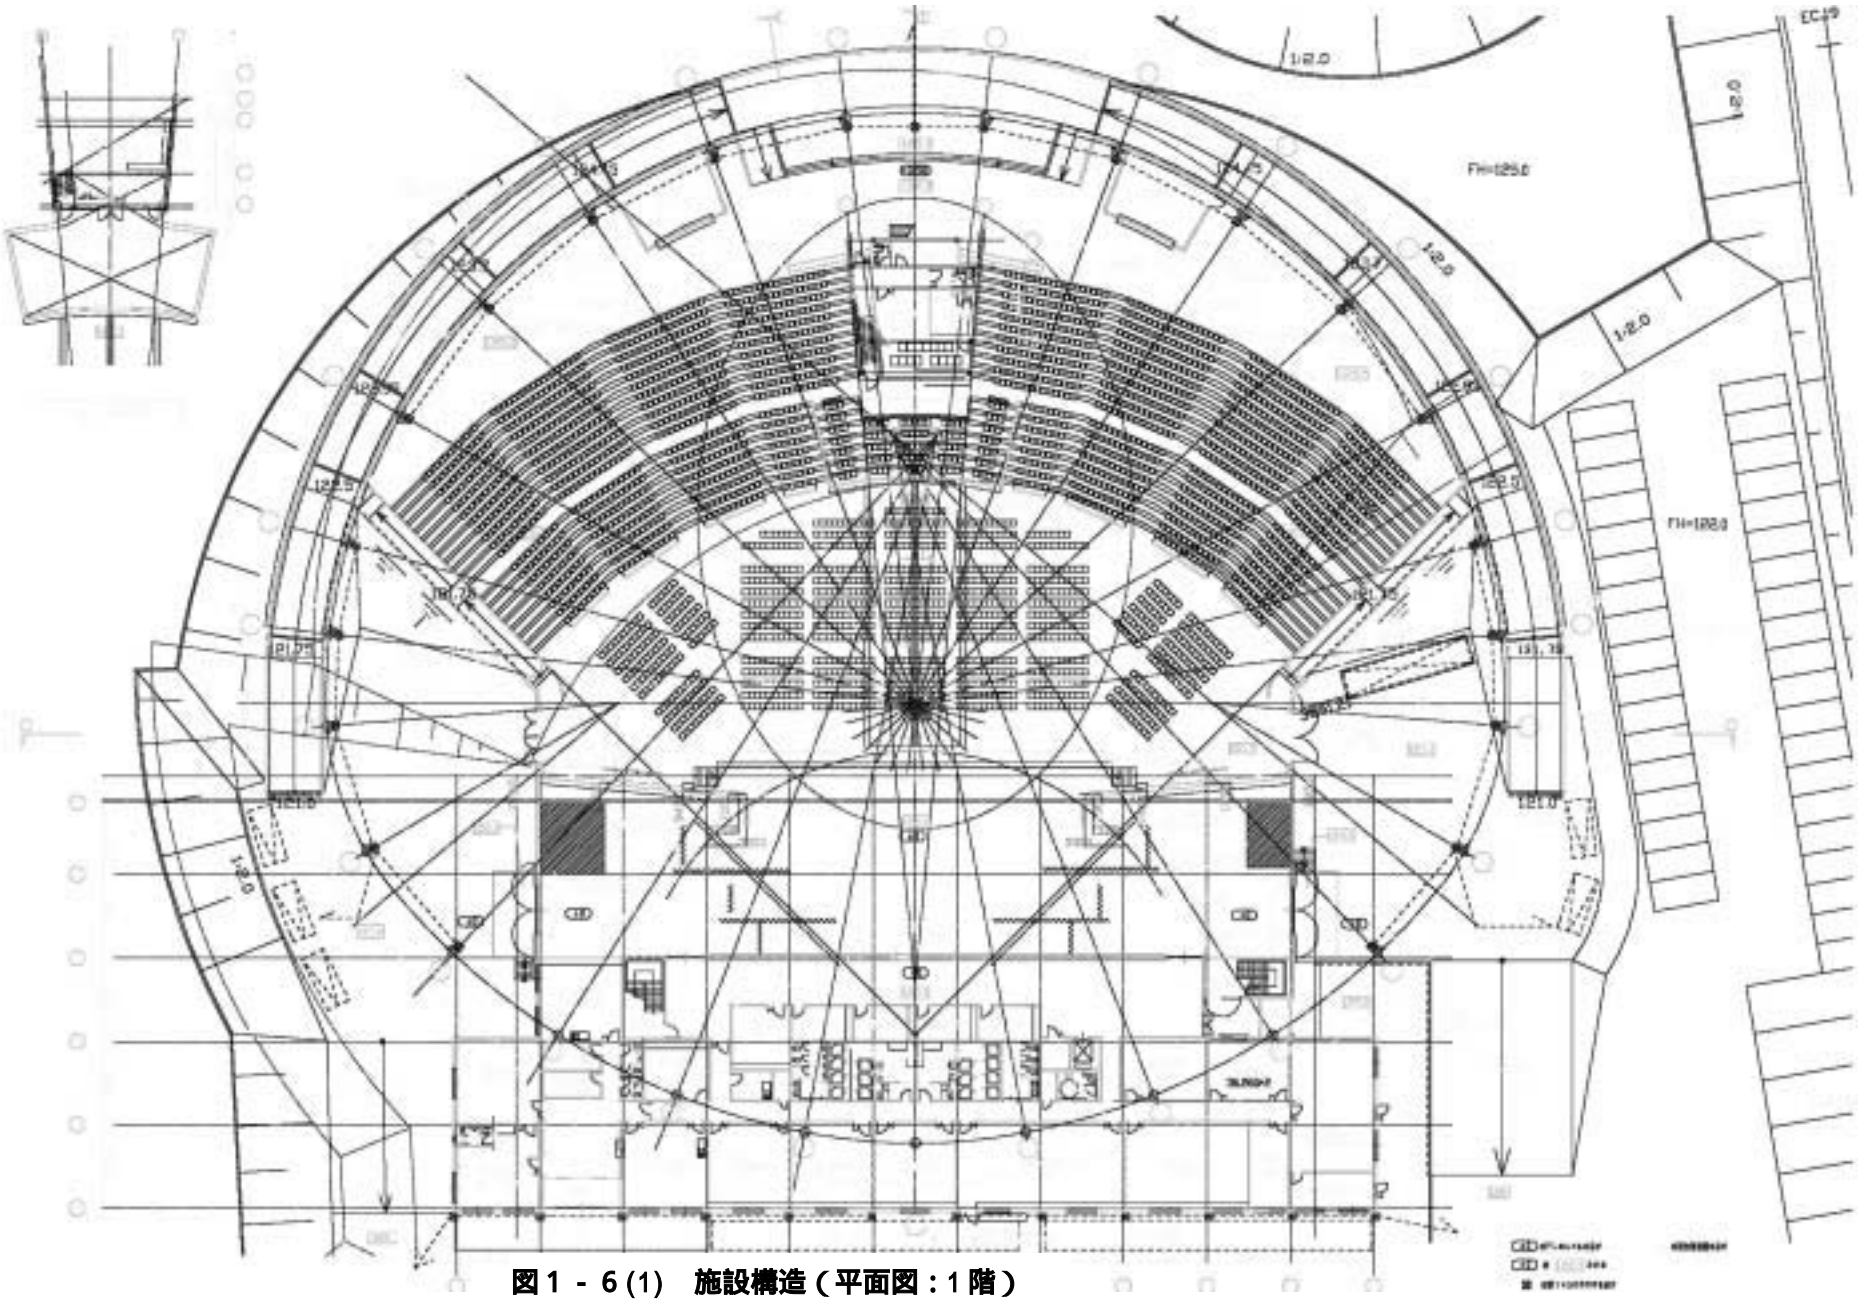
6 (1) 施設構造 (平面図 : 1 階)
